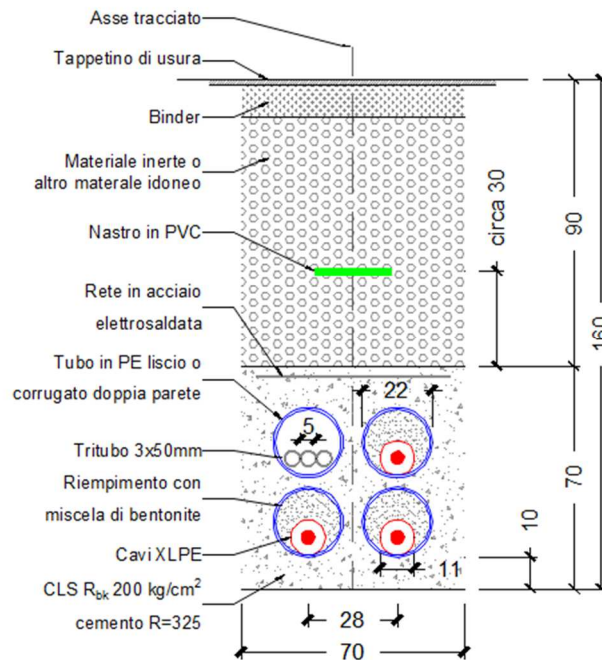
Sezione tipica di posa a trifoglio in attraversamento stradale
